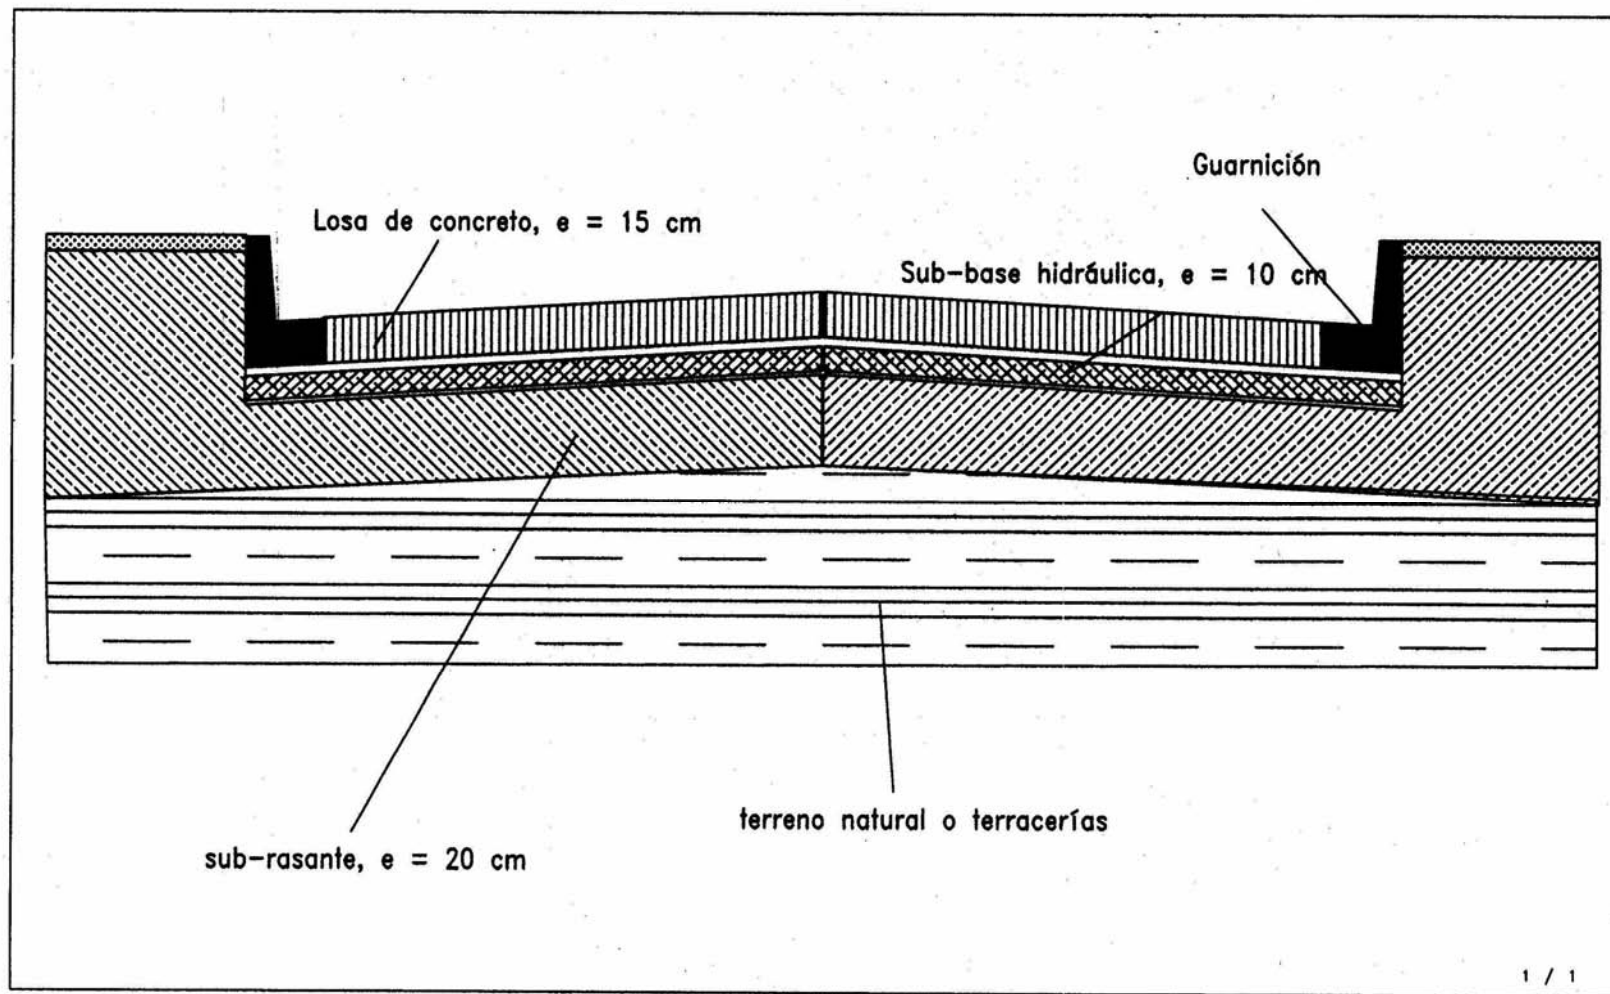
ESTRUCTURA DEL PAVIMENTO RÍGIDO DE LAS VIALIDADES INTERIORES.
